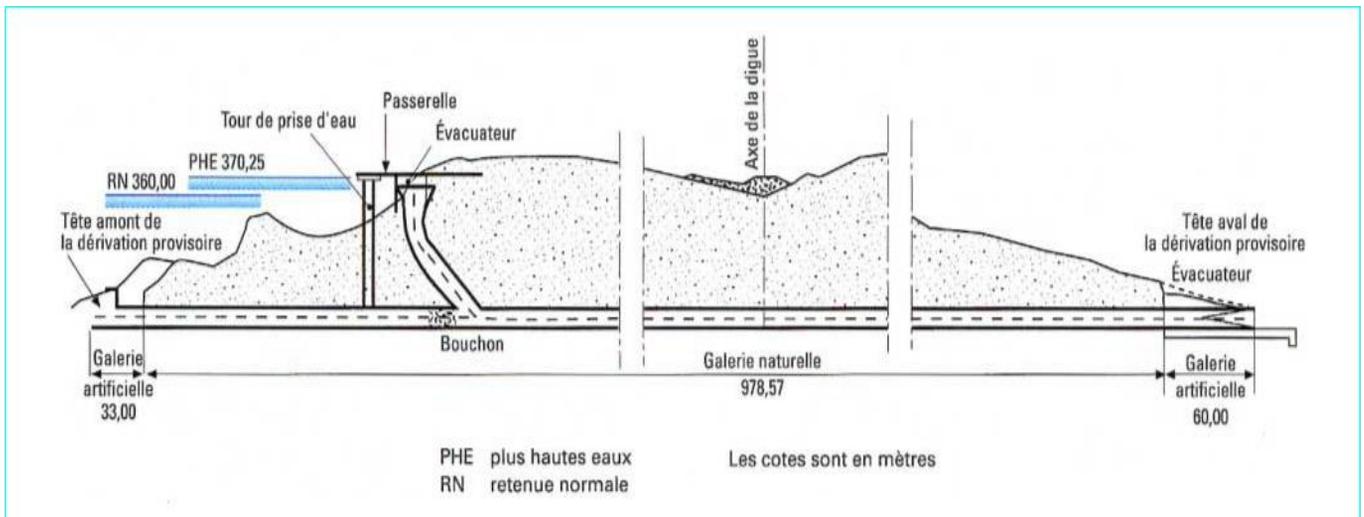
Évacuateur à puits et tunnel (Hamam Debagh, Algérie)
